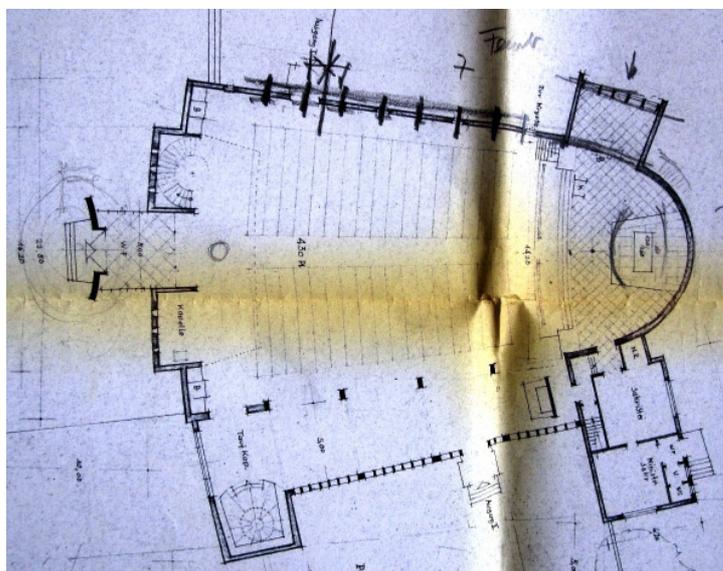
Vorentwurf für den Neubau. Plan 5b, Grundriss (Ausschnitt), O. Hodler, undatiert
